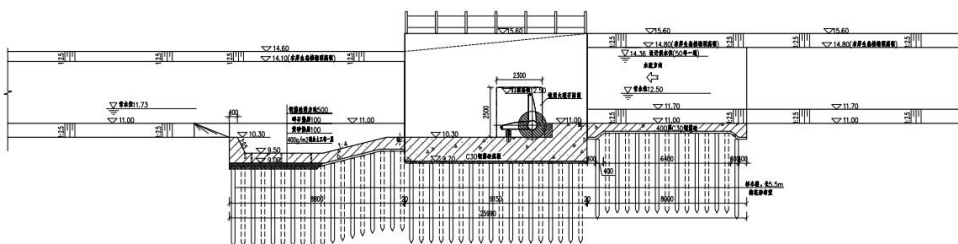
桩号 K2+136 钢坝闸纵剖面图
